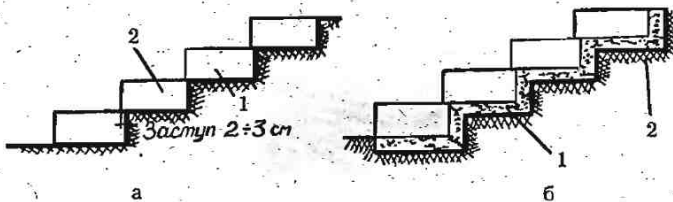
Профиль укладки лестницы из готовых бетонных блоков а) на слежавшемся грунте; 1 — грунт; 2 — блок; б) на насыпном грунте: 1 — основание из бутового камня; 2 — утрамбованный грунт
